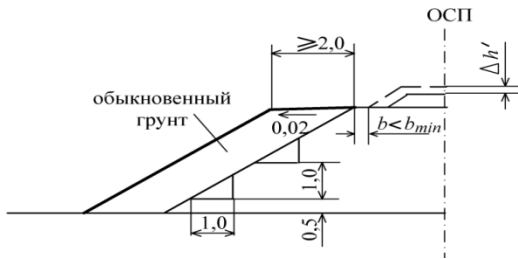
Реконструкция земляного полотна однопутной железной дороги при досыпках на насыпи с нарезкой уступов
